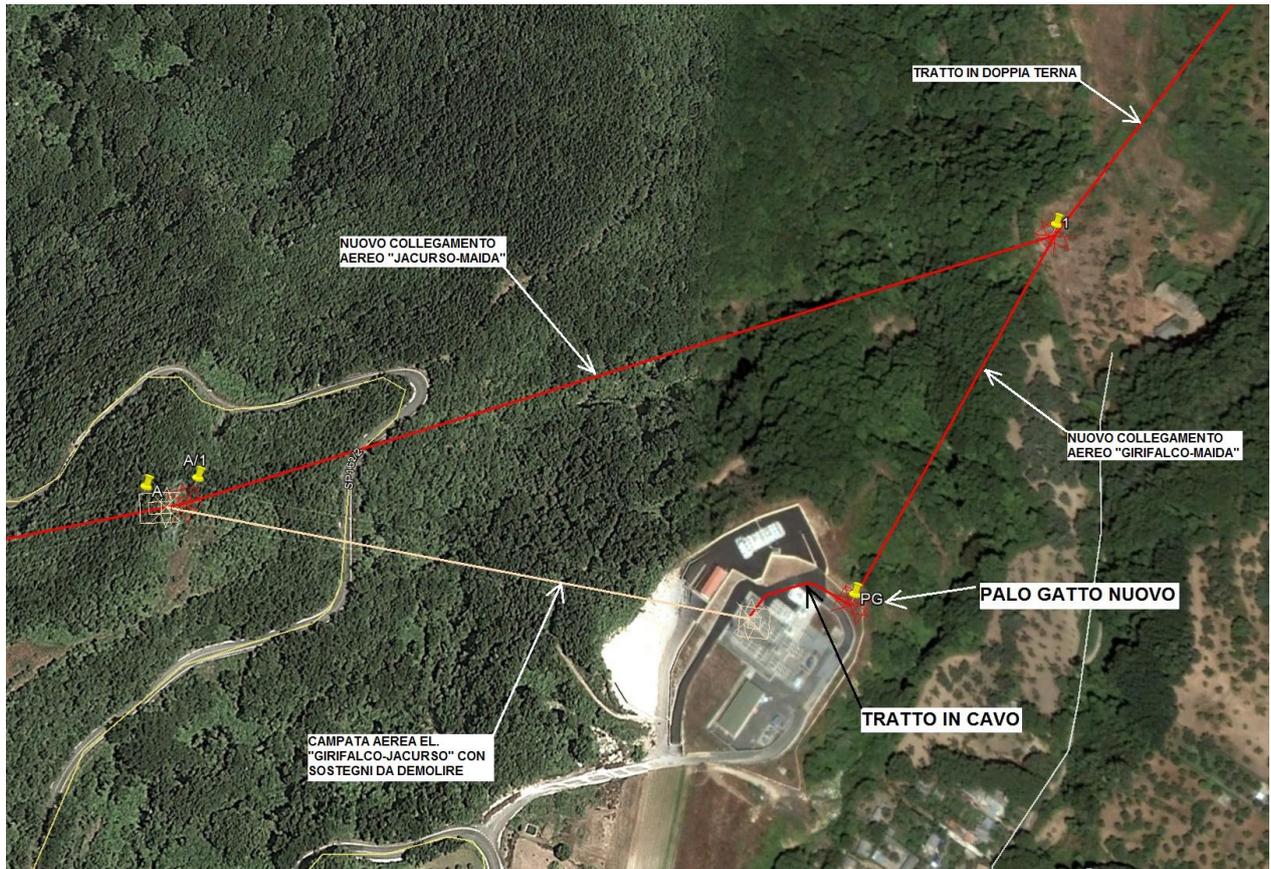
Porzione delle opere in progetto su ortofoto nei pressi della CP di Girifalco.
